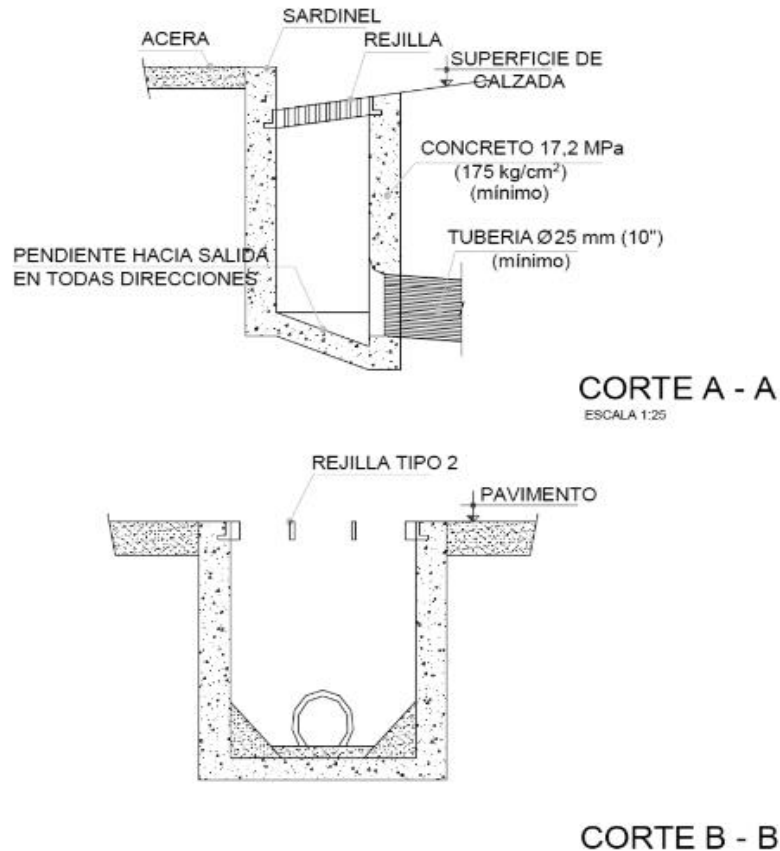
Sumidero Tipo S2 Conectado a la Tubería
